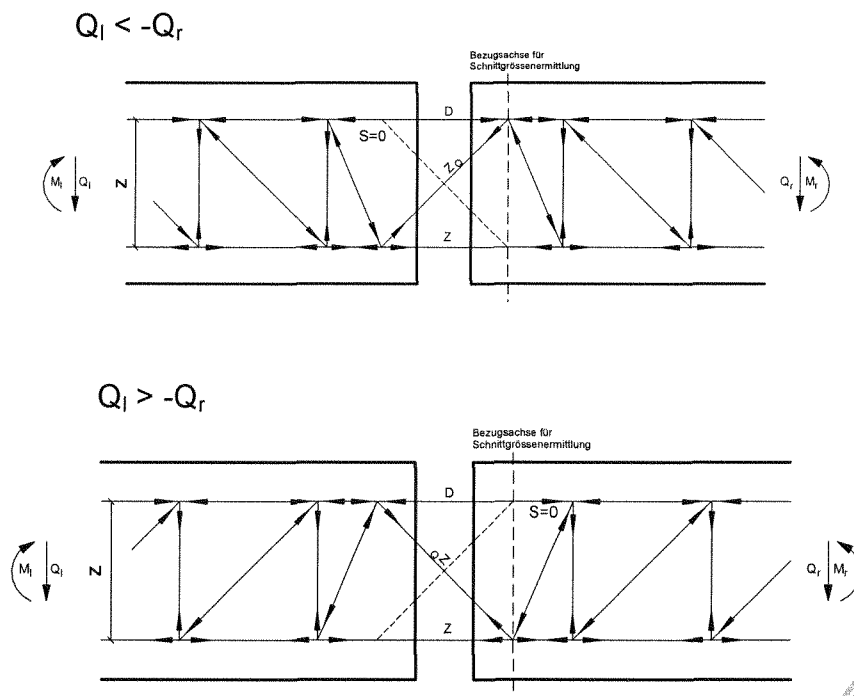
egcobox Kragplattenelement Fachwerkmodell Typ P +/-
